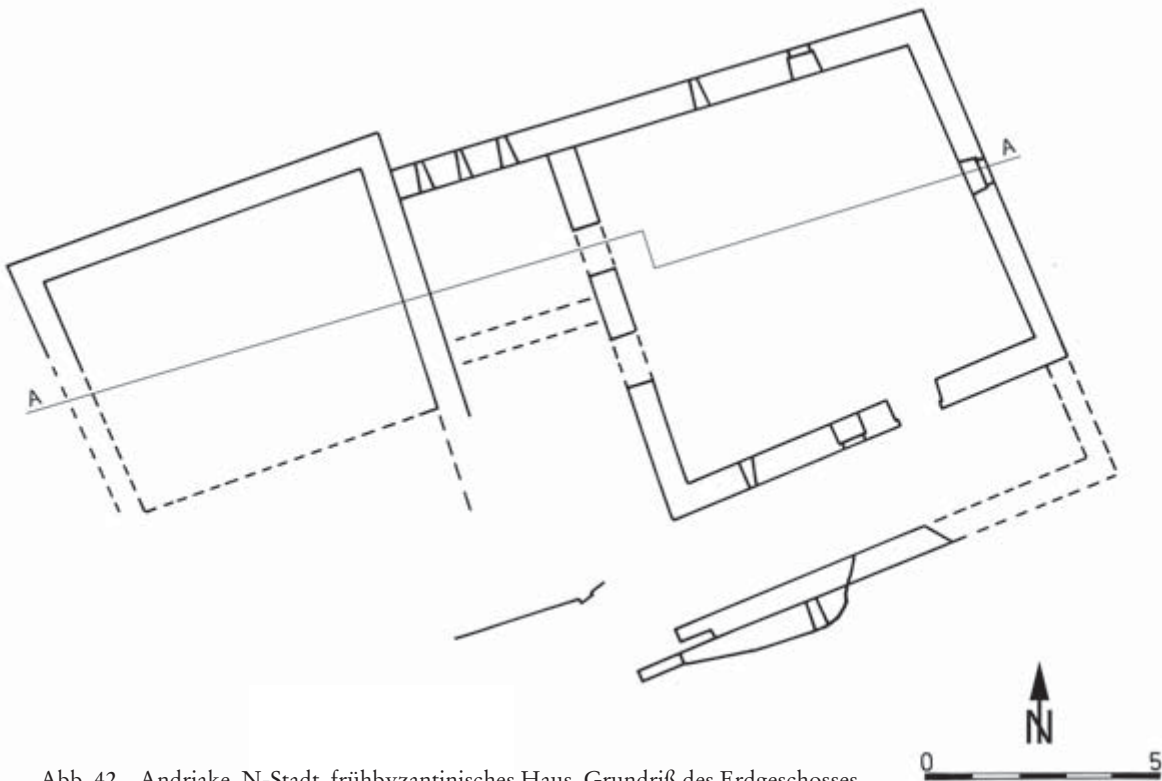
Andriake, N-Stadt, frühbyzantinisches Haus, Grundriß des Erdgeschosses
